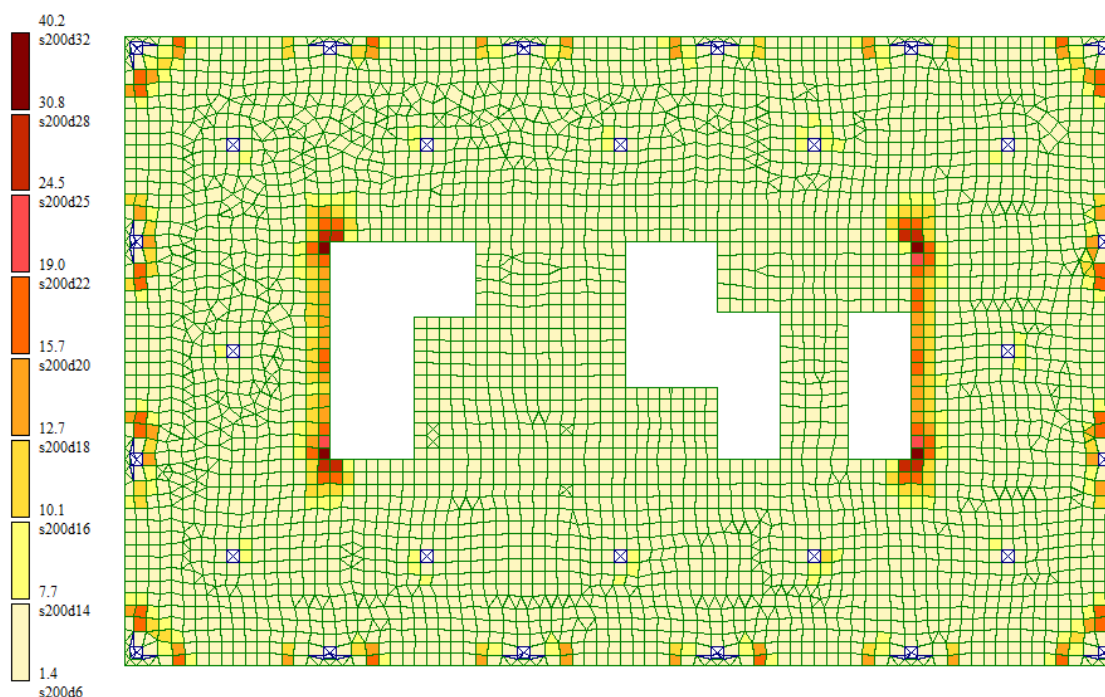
Схема армирования верха плит перекрытий по оси ОХ
